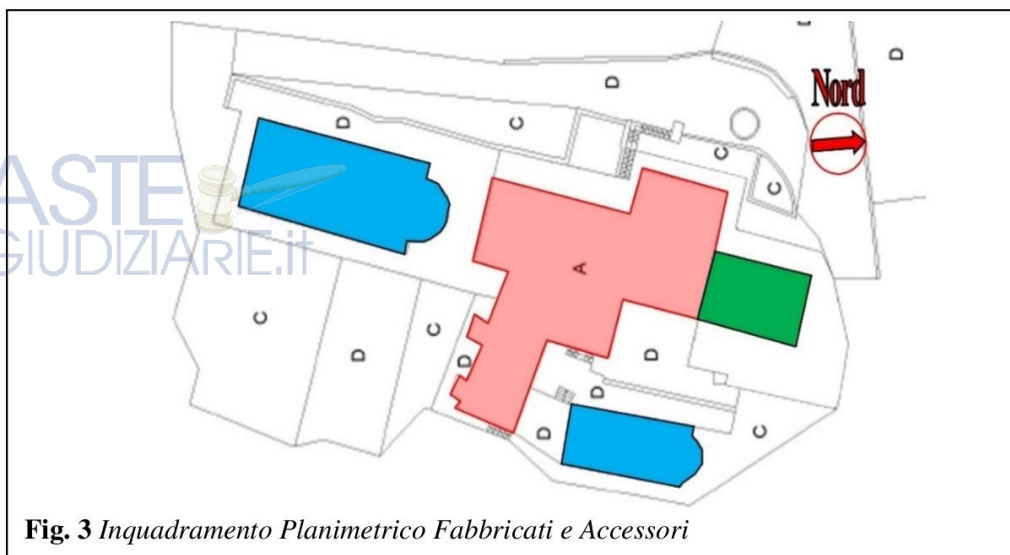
Inquadramento Planimetrico Fabbricati e Accessori
